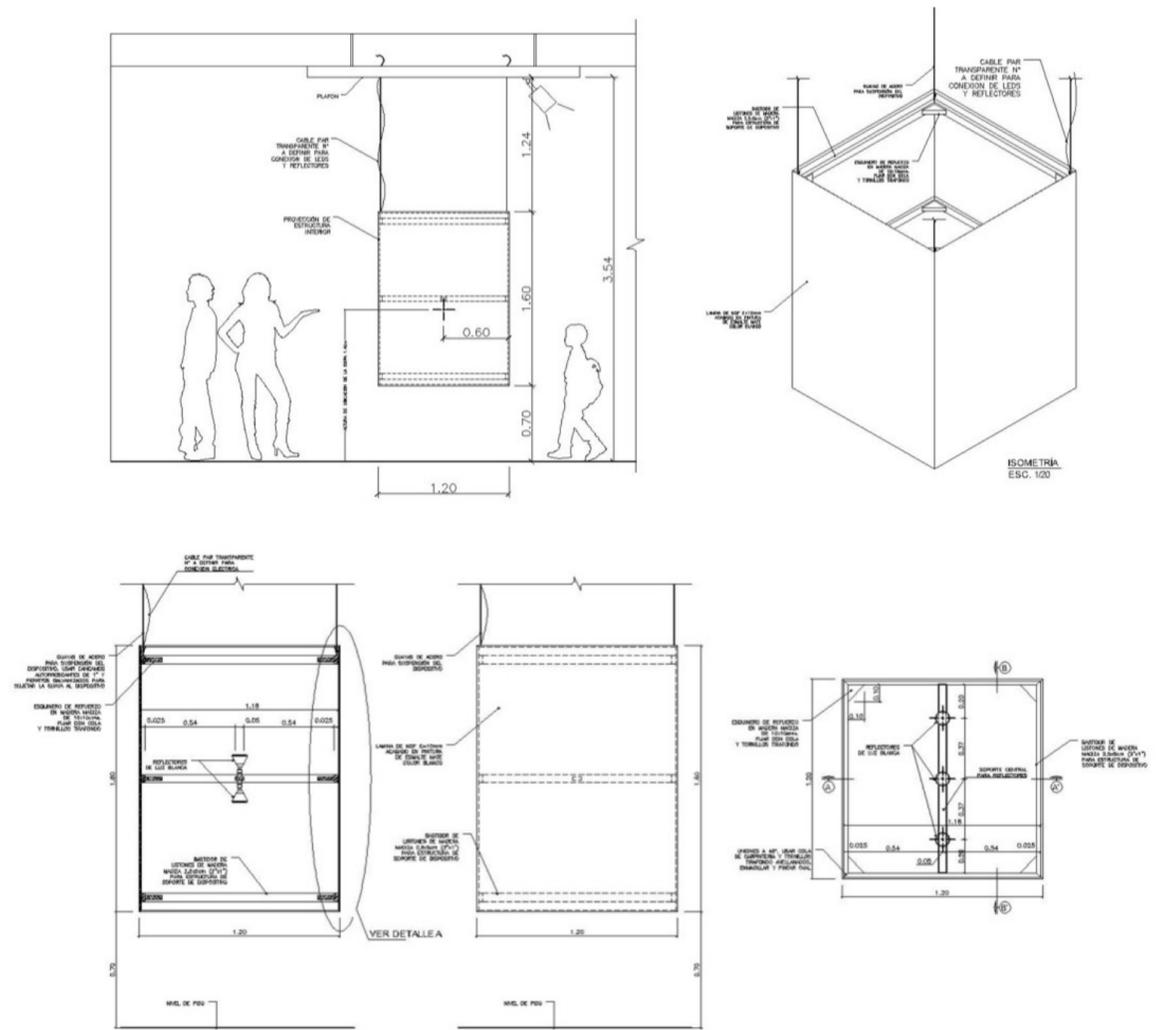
Elevaciones y planos de detalles constructivos del dispositivo museográfico. Elaboración propia.
